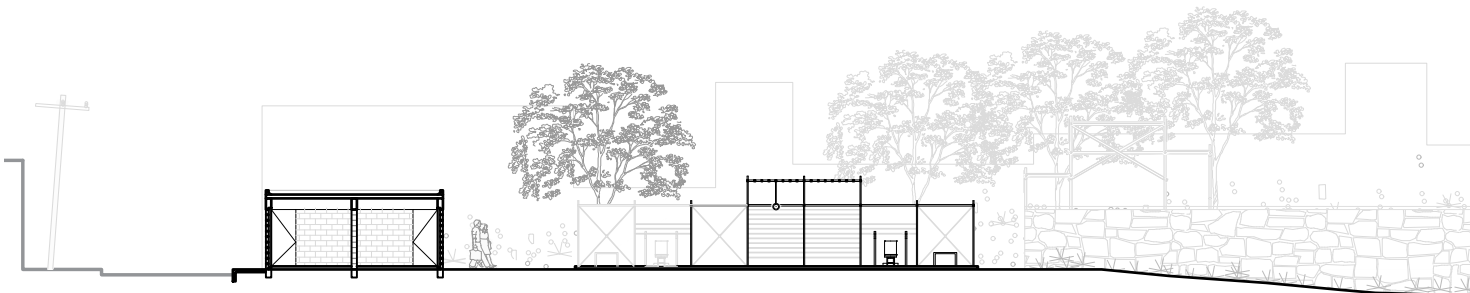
Fachada de conjunto, imagen objetivo
